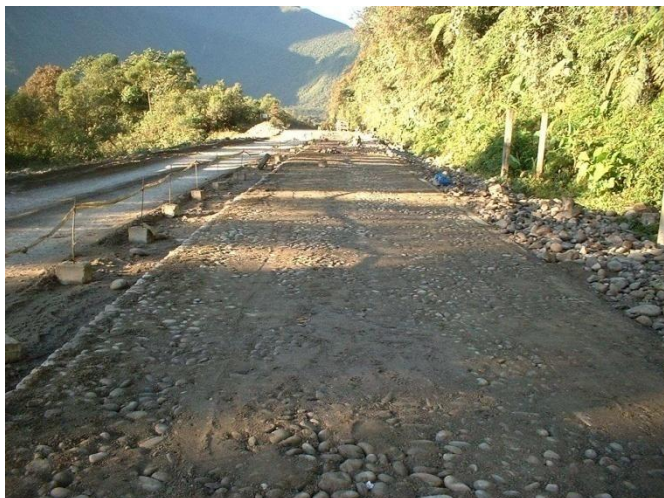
Colocación de Maestras o Cordones maestros Fuente: OIT
